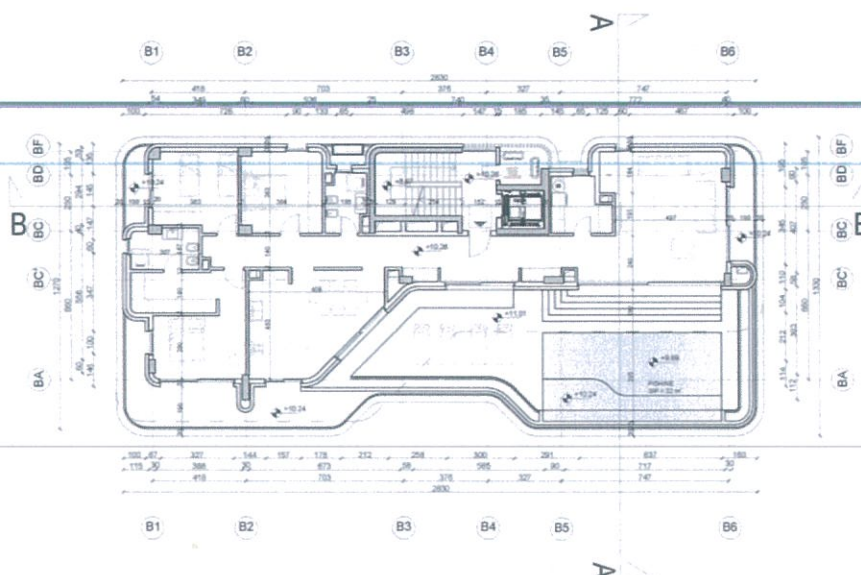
Planimetria e katit të fundit Banim (Objekti B+C)
